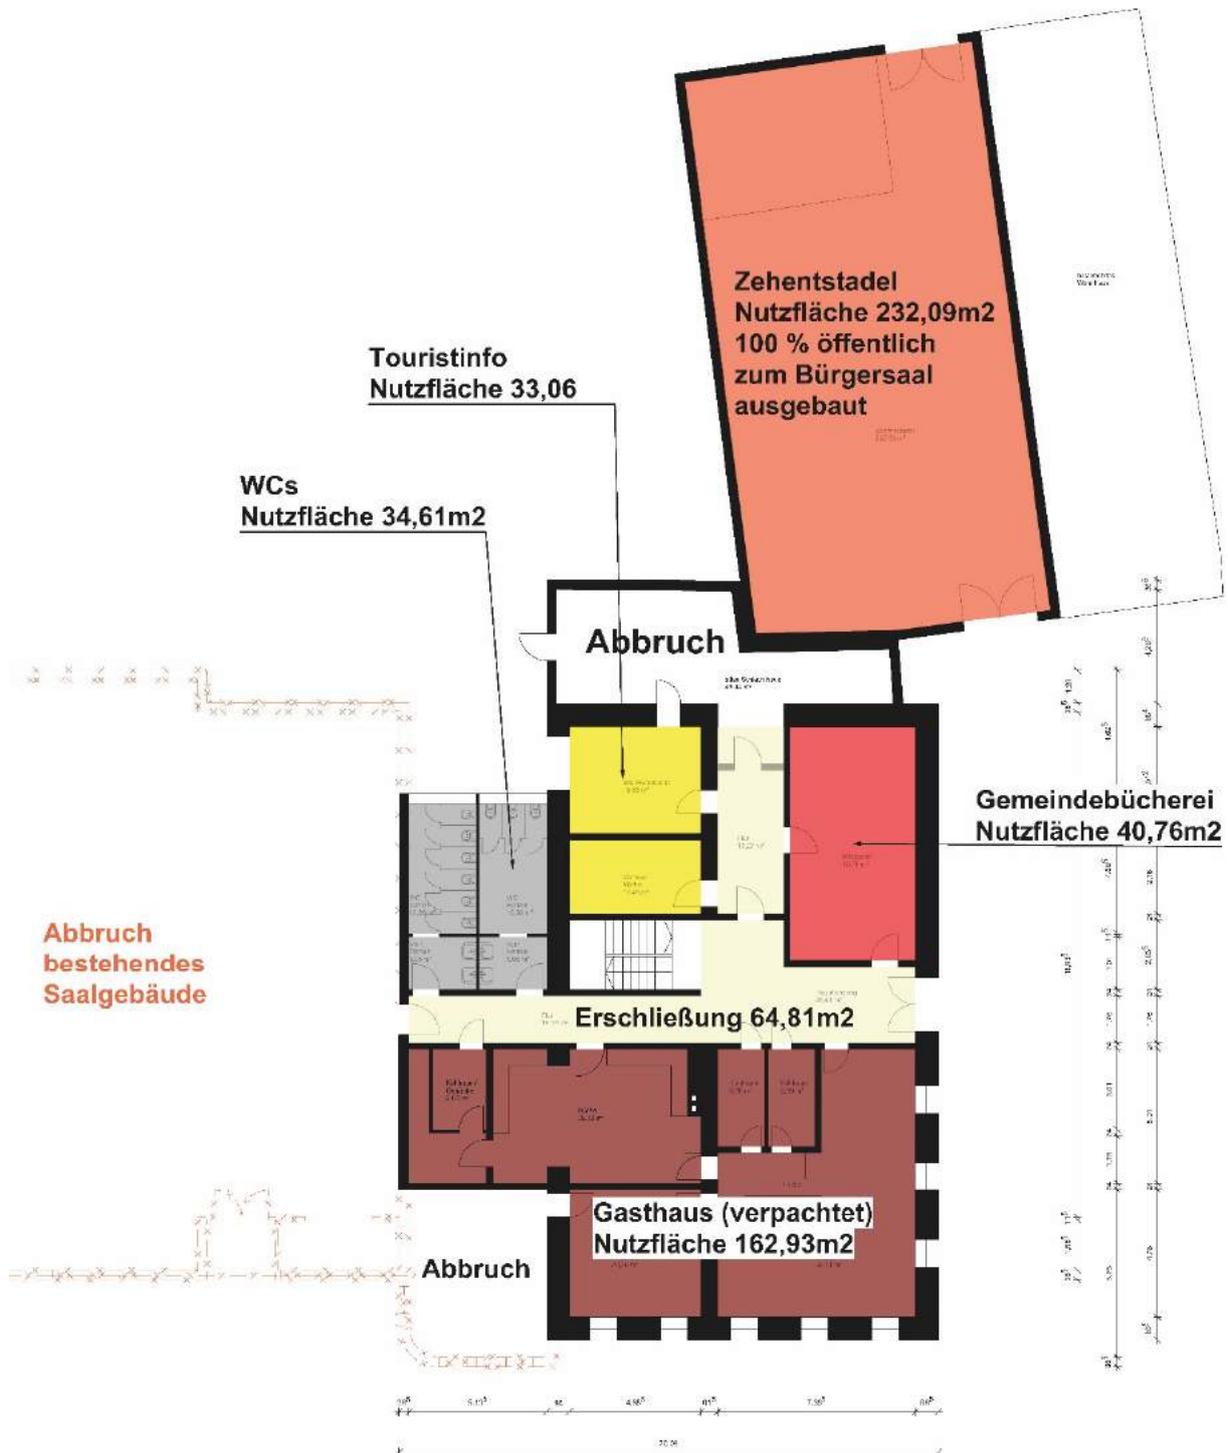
Dorfzentrum Lalling, Variante II, Erdgeschoß
